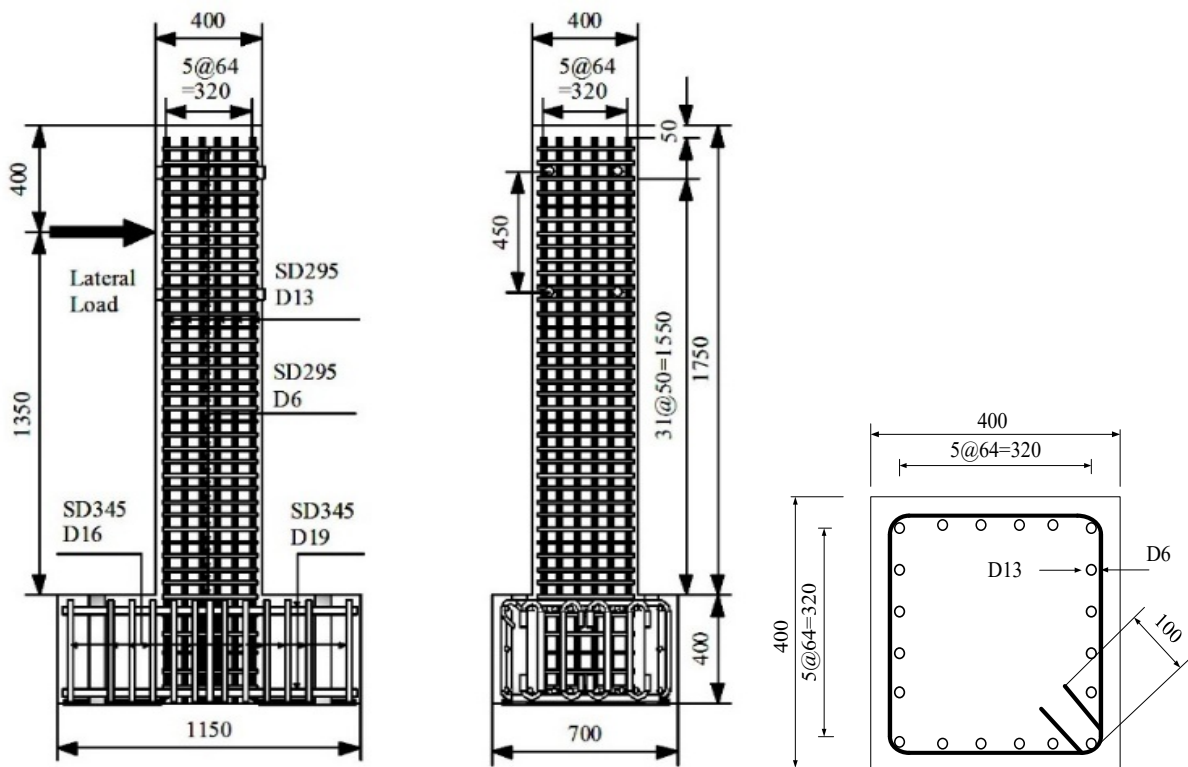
Détails de ferrailage des spécimens tp031~tp034
